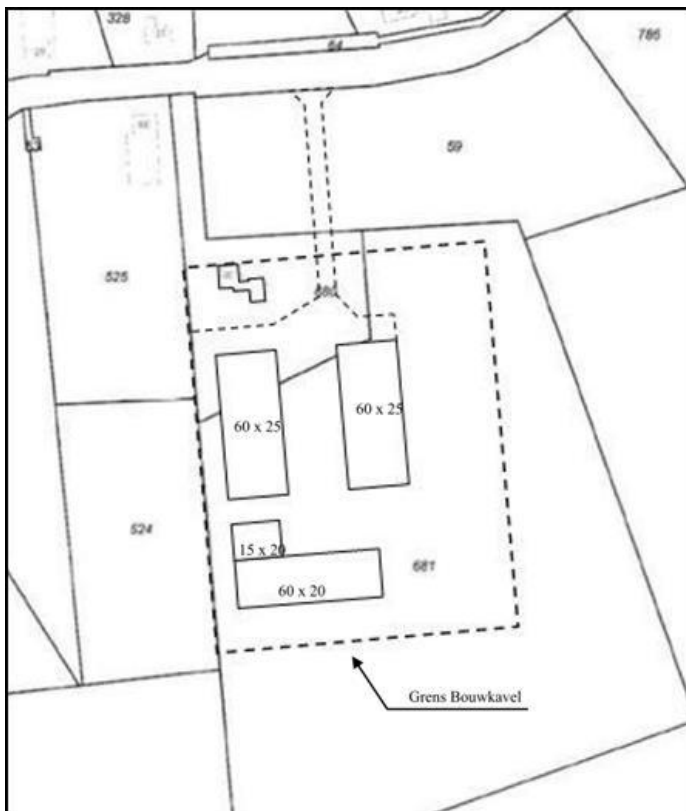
Uitsnede verbeelding vigerend bestemmingsplan c.q. tijdelijk omgevingsplan
